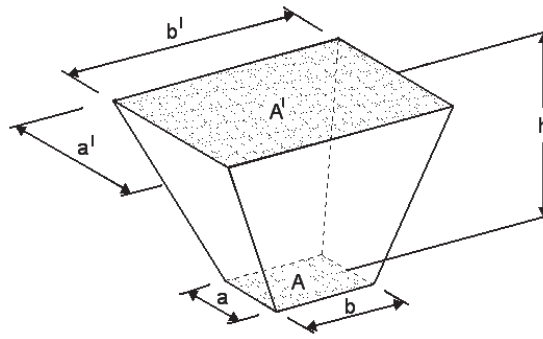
Kesik Piramit Şeklindeki Temel Kazısının Planı ve Kesitleri
